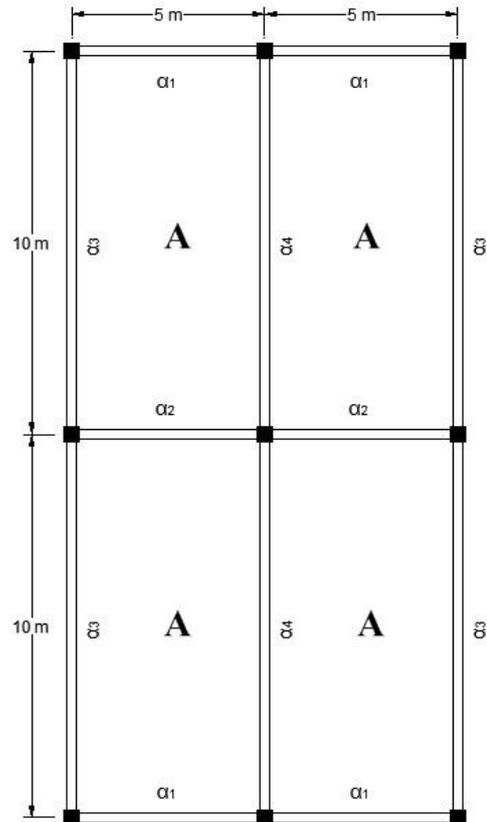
Denah Model Struktur Tipe B1 (tanpa balok anak)
